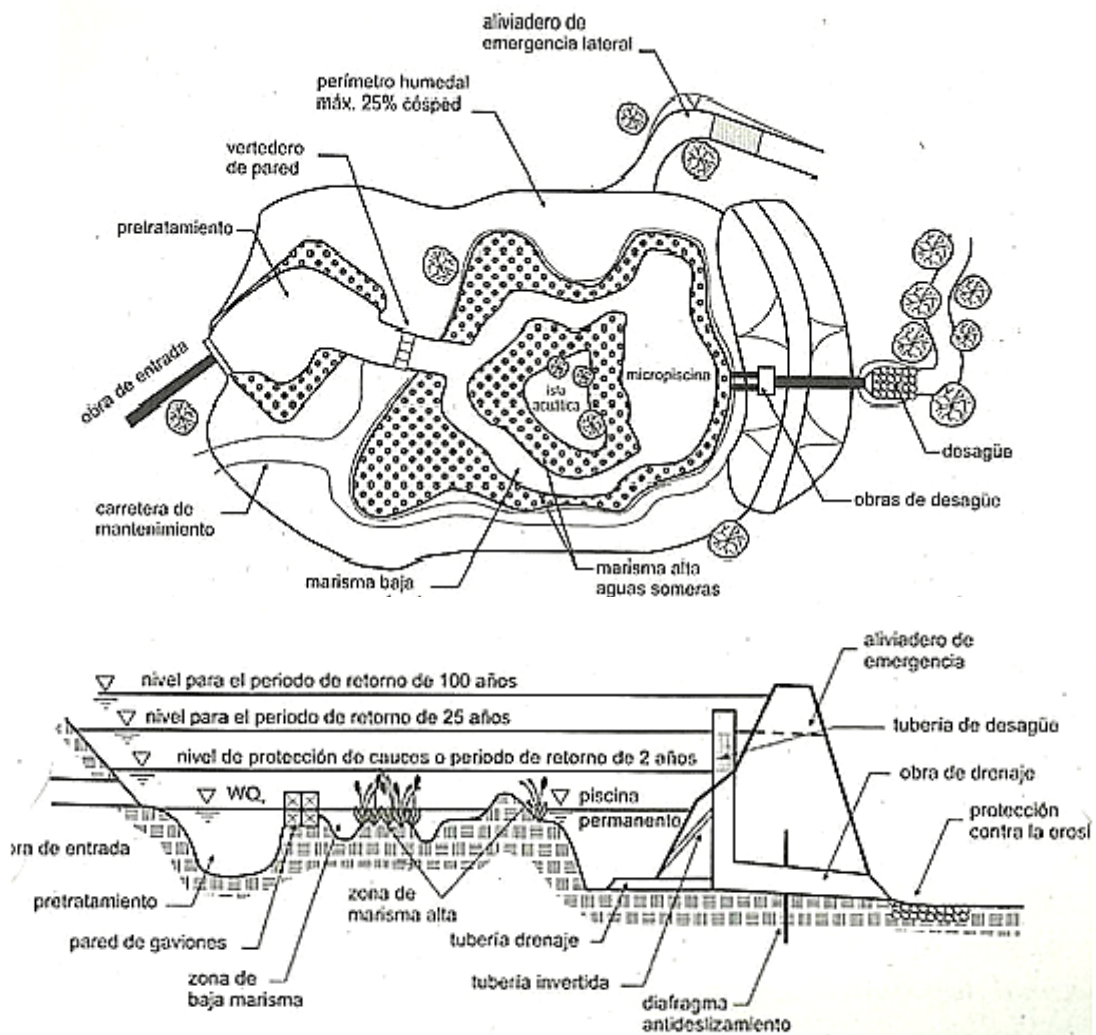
Esquema de la planta y el perfil de un humedal. Fuente: CEDEX (2008).
